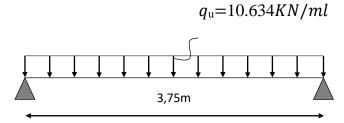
Schéma statique de la poutre de chainage (ELS)
